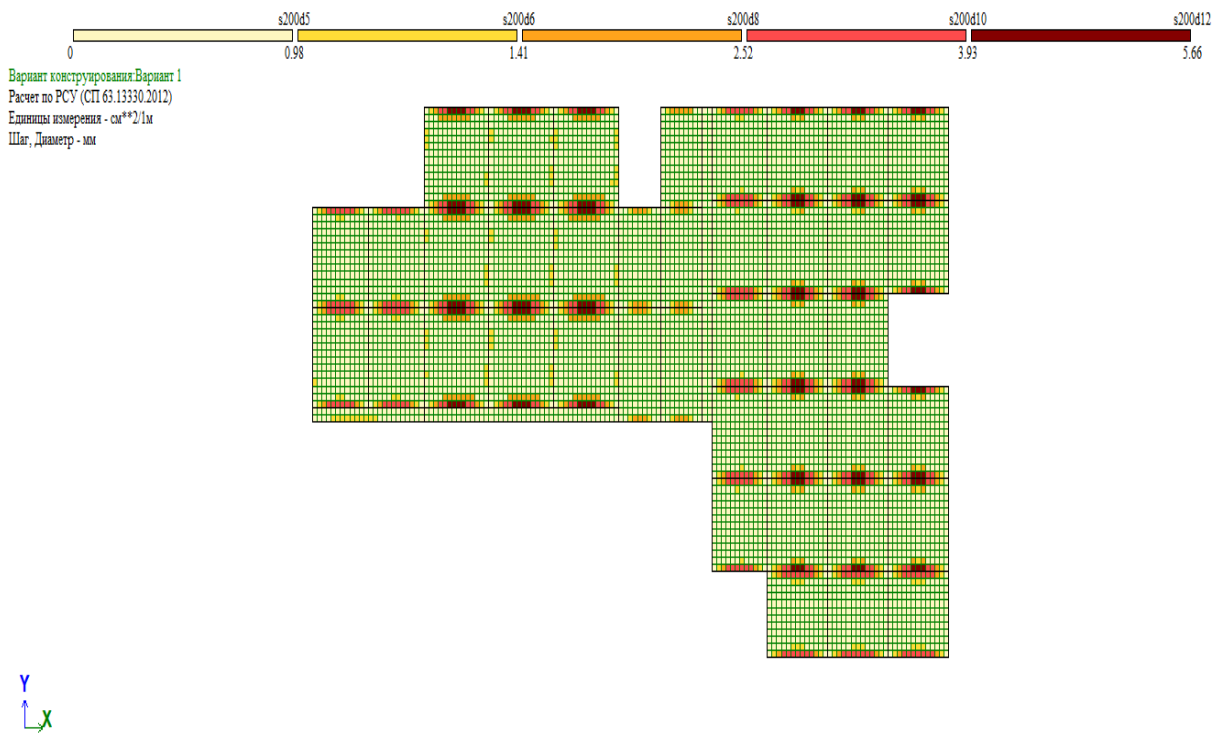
Площадь арматуры по верхней грани плиты перекрытия по оси Y
